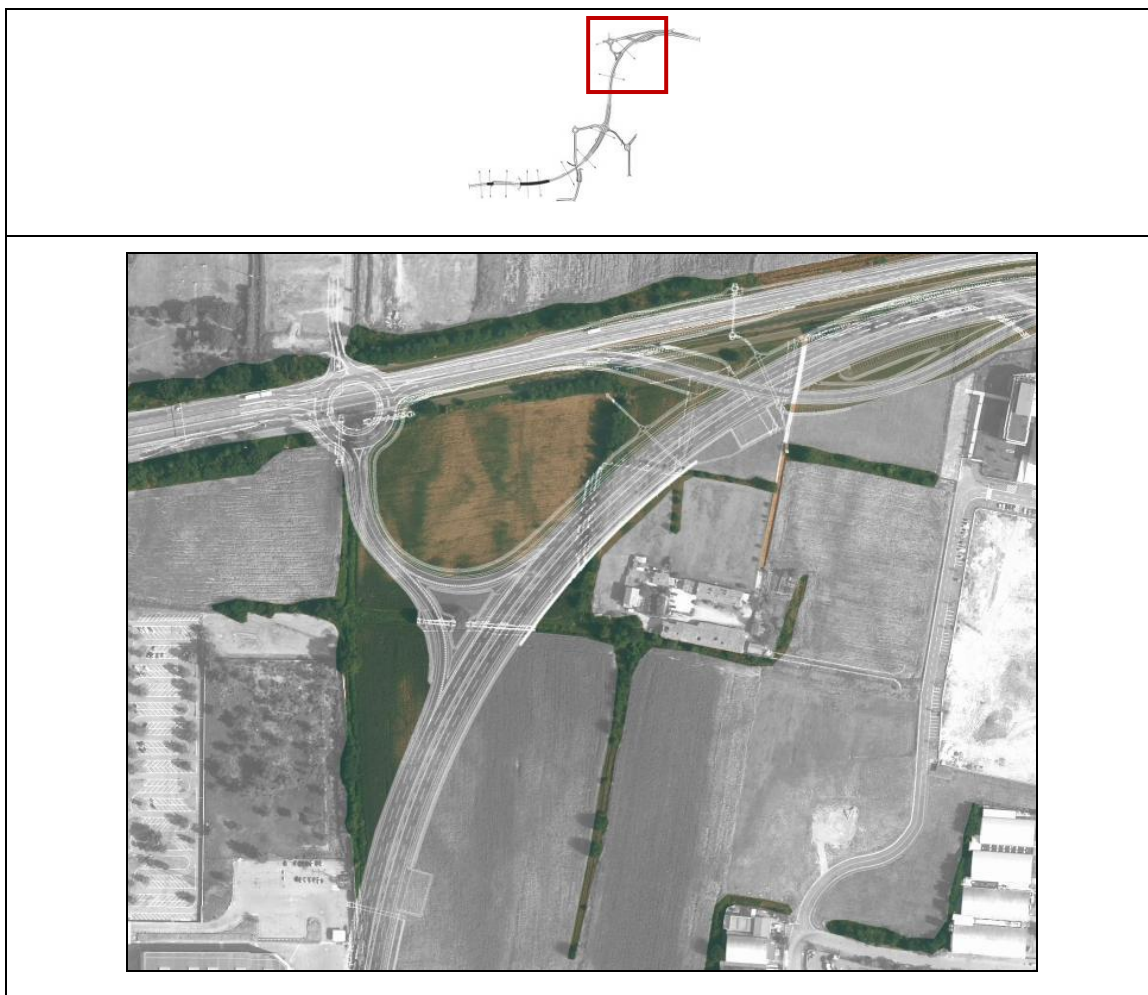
Porzione finale dell'intervento – Obiettivi di mitigazione rispetto al progetto.
